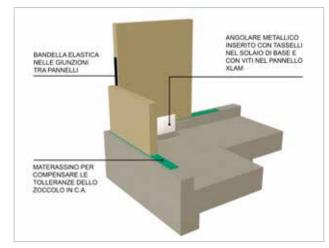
Collegamento al cordolo di fondazione con piastre.
